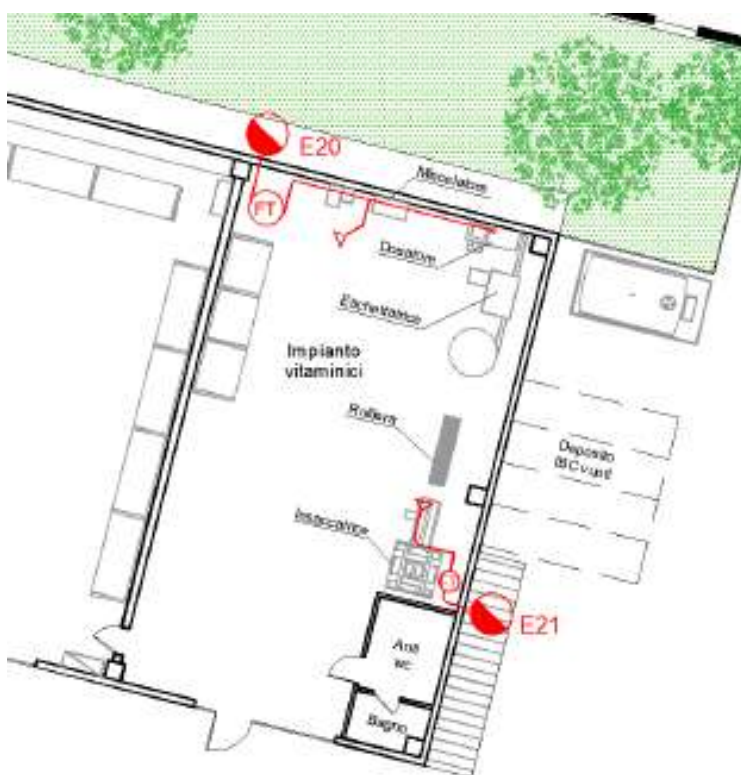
Estratto planimetria emissioni – Porzione fabbricato 2
